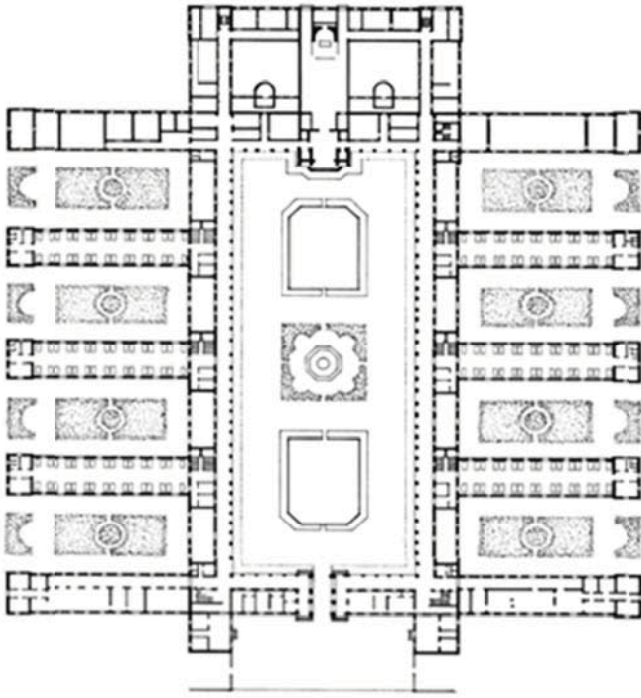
Pianta del progetto per l'Ospedale Lariboisier, Parigi, 1839-54
